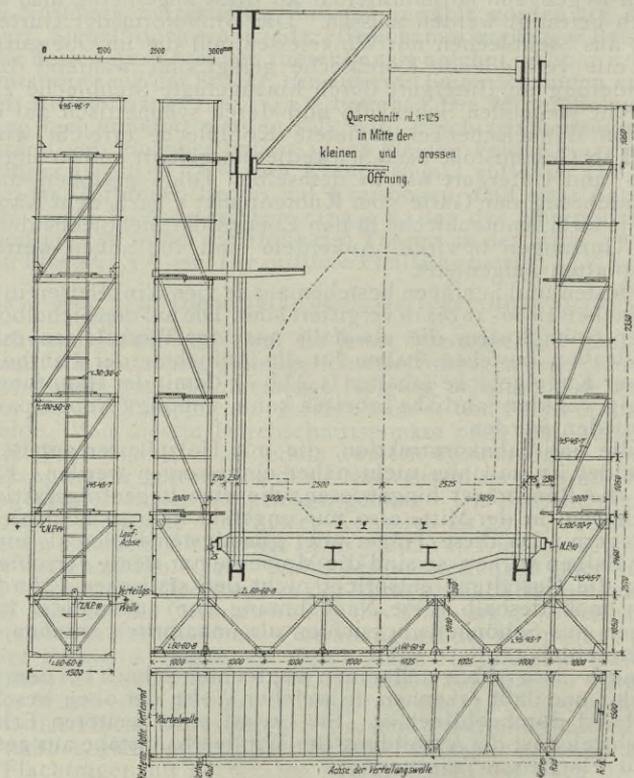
Querschnitt der Brücke mit Besichtigungswagen.
